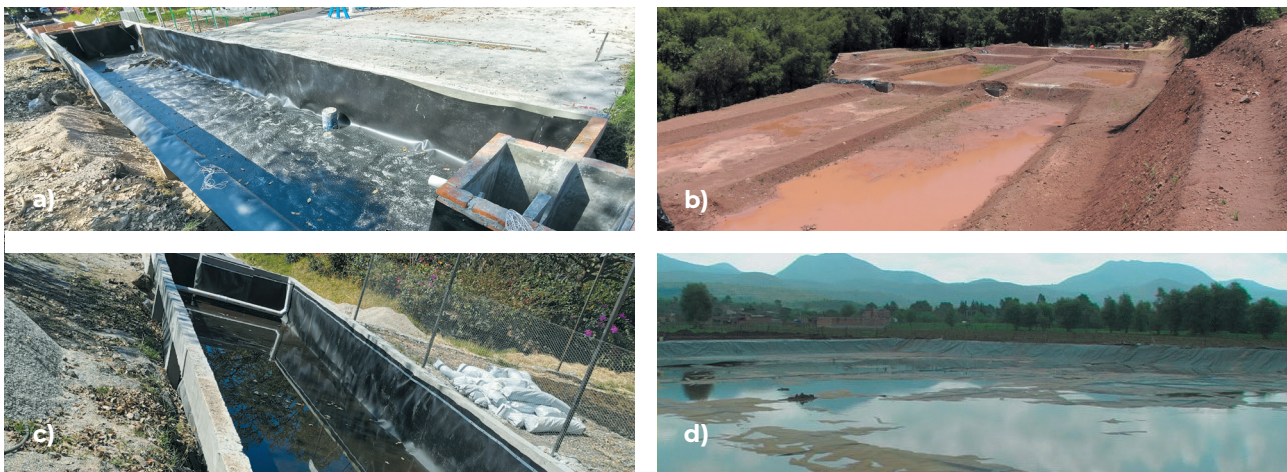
Impermeabilización de los estanques: a) arcilla altamente impermeable, b, c y d) geomembrana.
